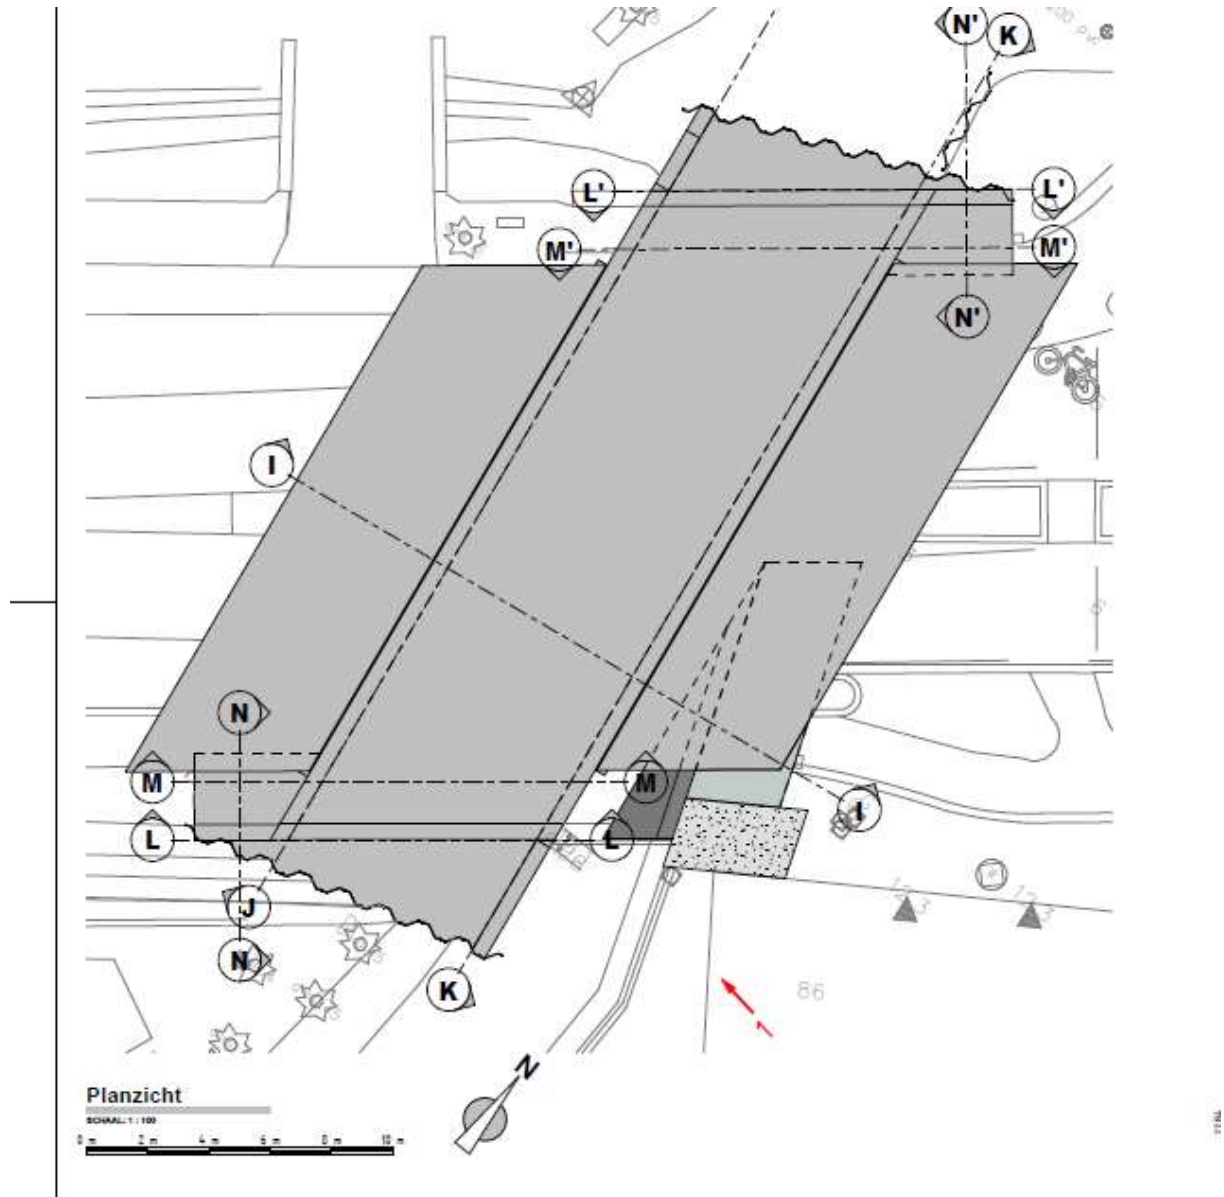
Planzicht van de nieuwe koker ter hoogte van N8
